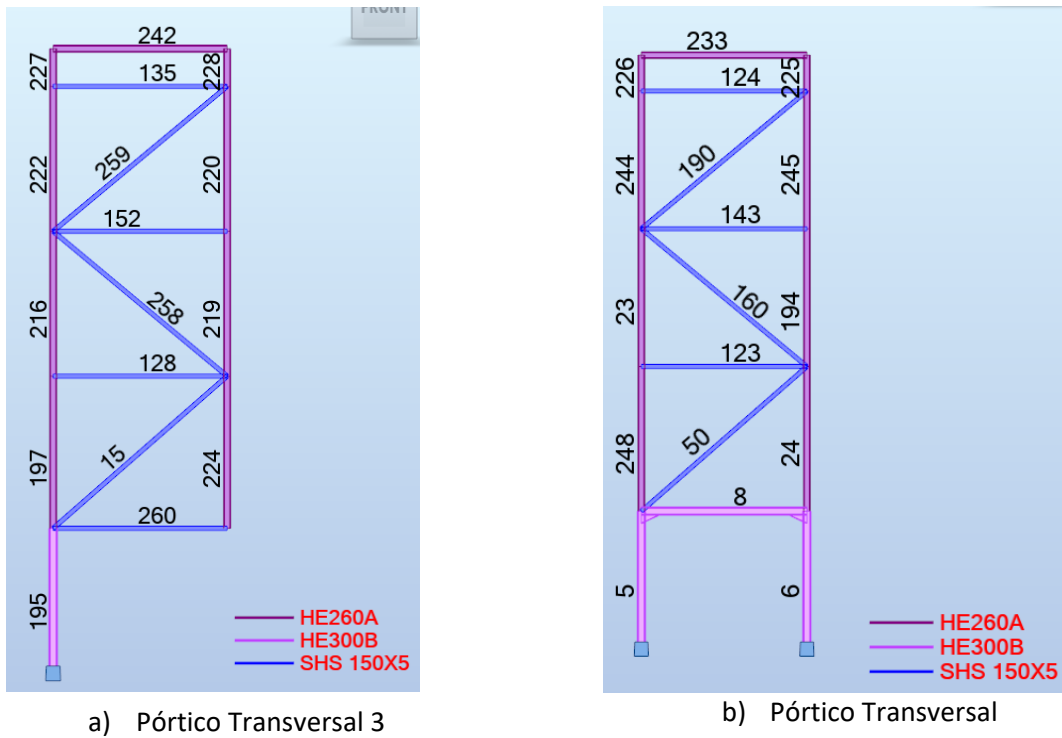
Pórticos 3 e 4 Transversais com os elementos estruturais numerados
